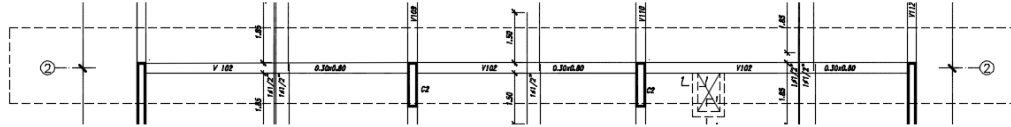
Ubicación de la viga del primer encofrado eje “2”.
